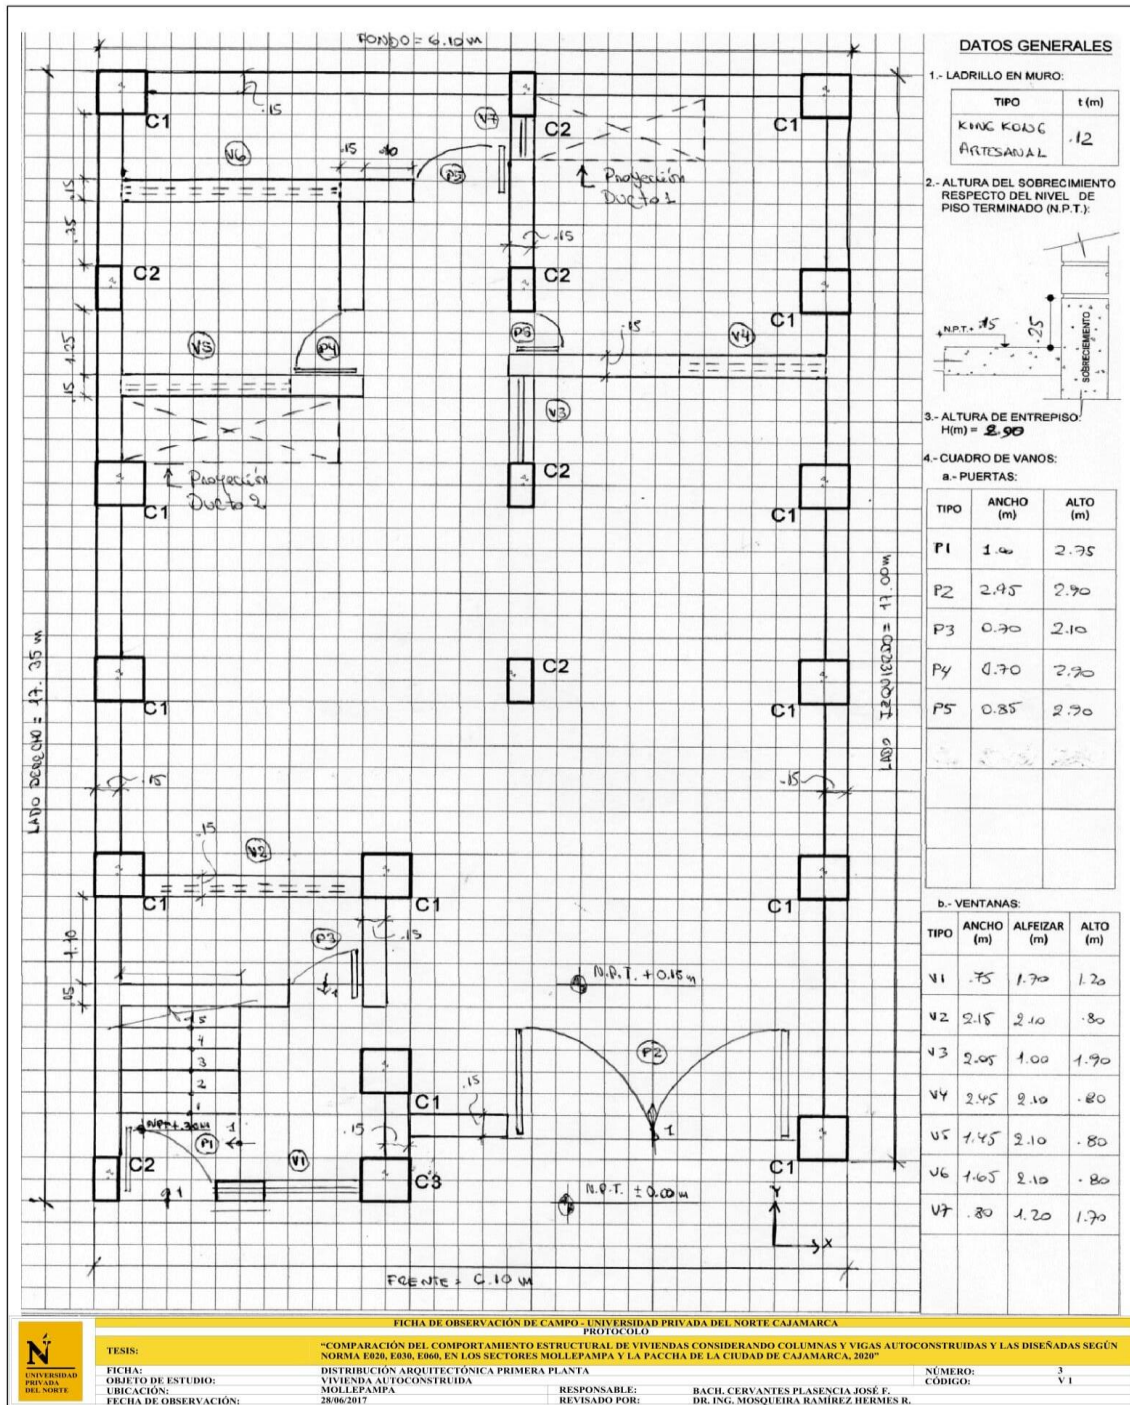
Ficha de arquitectura 1° planta vivienda 1.
